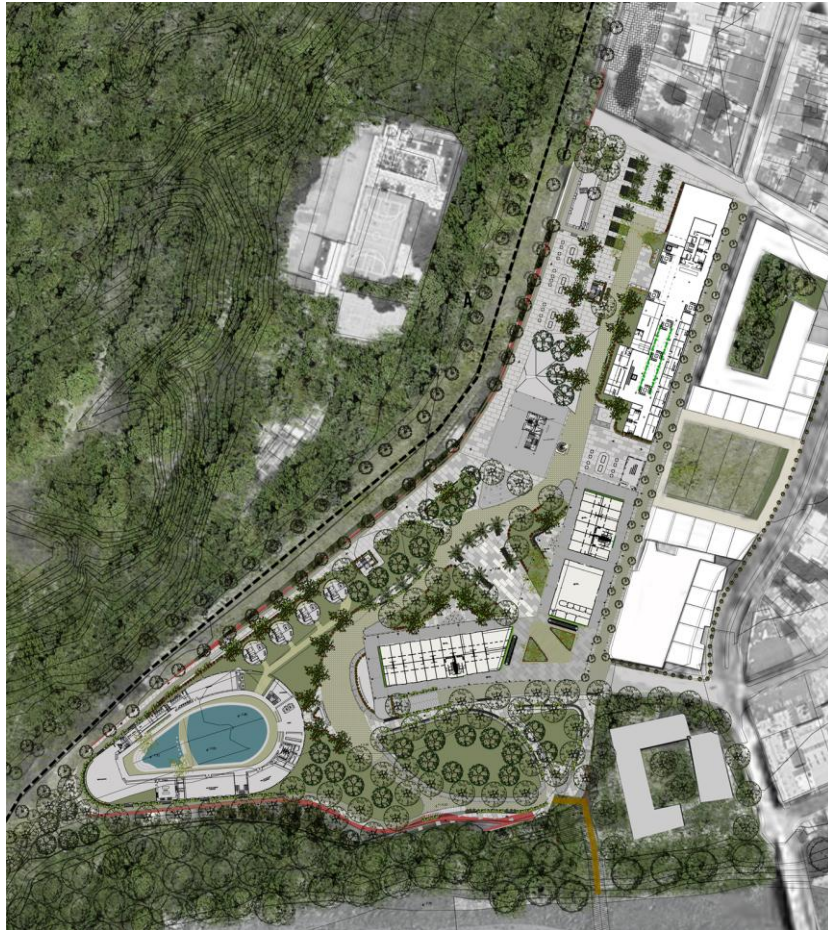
Vista al Interior del Proyecto II - Propuesta.
